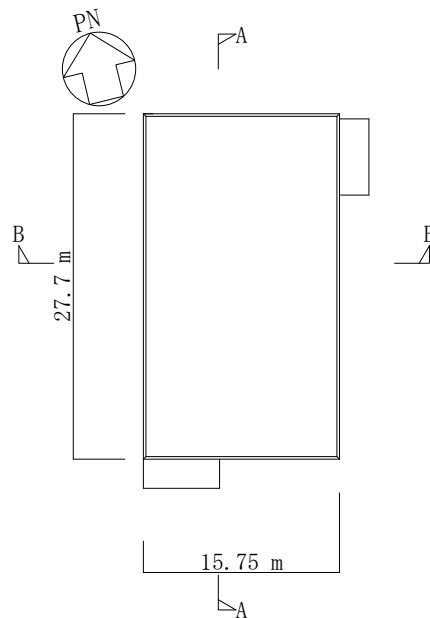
(5/5) 緊急時対策所建屋の概略平面図 (R 階平面図 : EL. 51.0 m)
